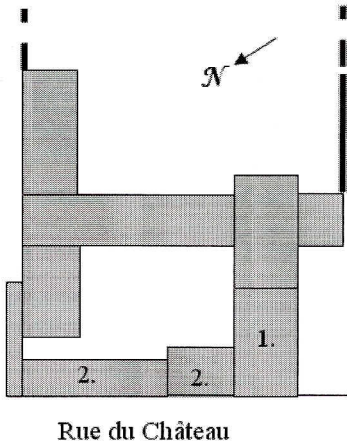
Tournai, rue du Château, plan schématique du couvent des Célestines (vers 1700)
